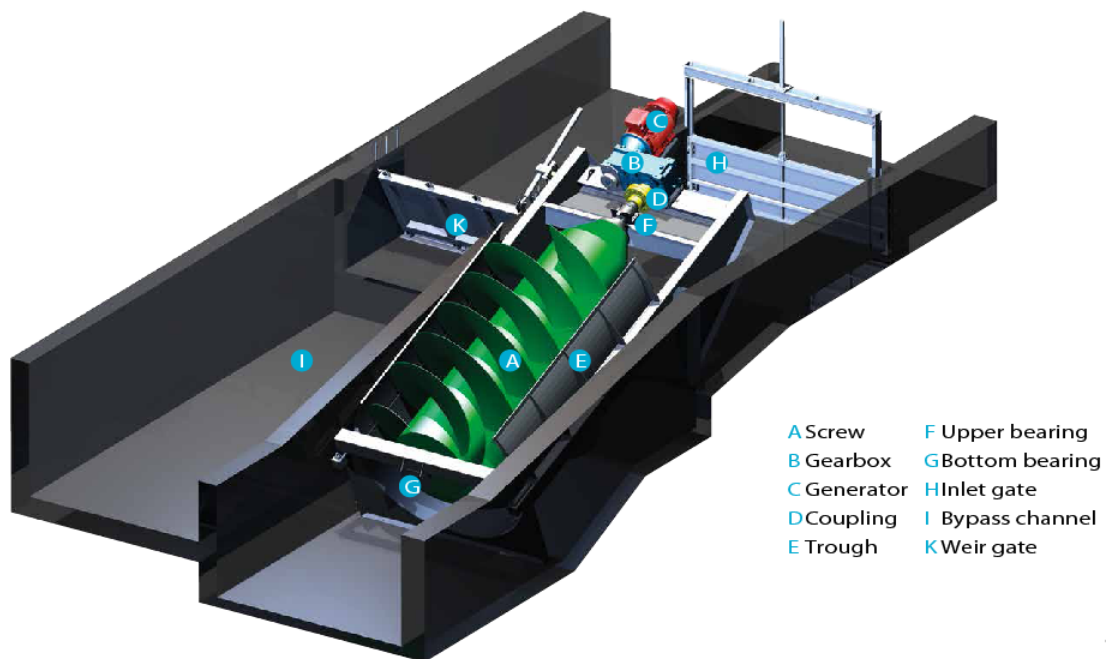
Vista assonometrica instalalzione turbina a coclea
